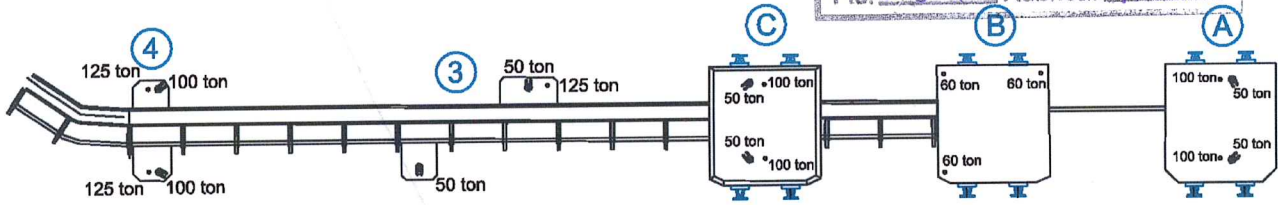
Planimetria do arranjo geral atual do Pier Norte.
